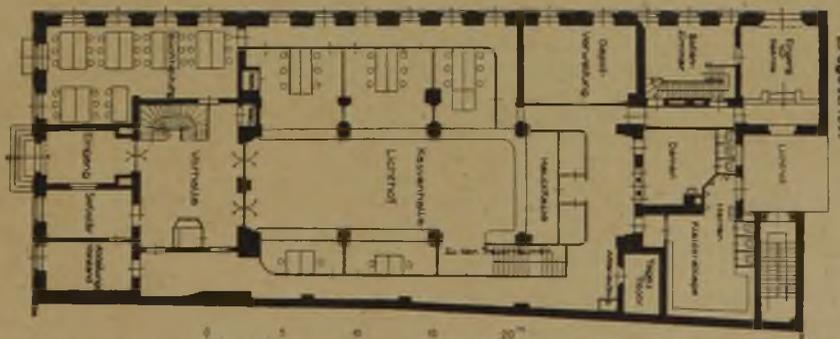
Grundriß des Erdgeschosses nach dem Umbau. Umbau der Girozentrale Pommern in Stettin.
